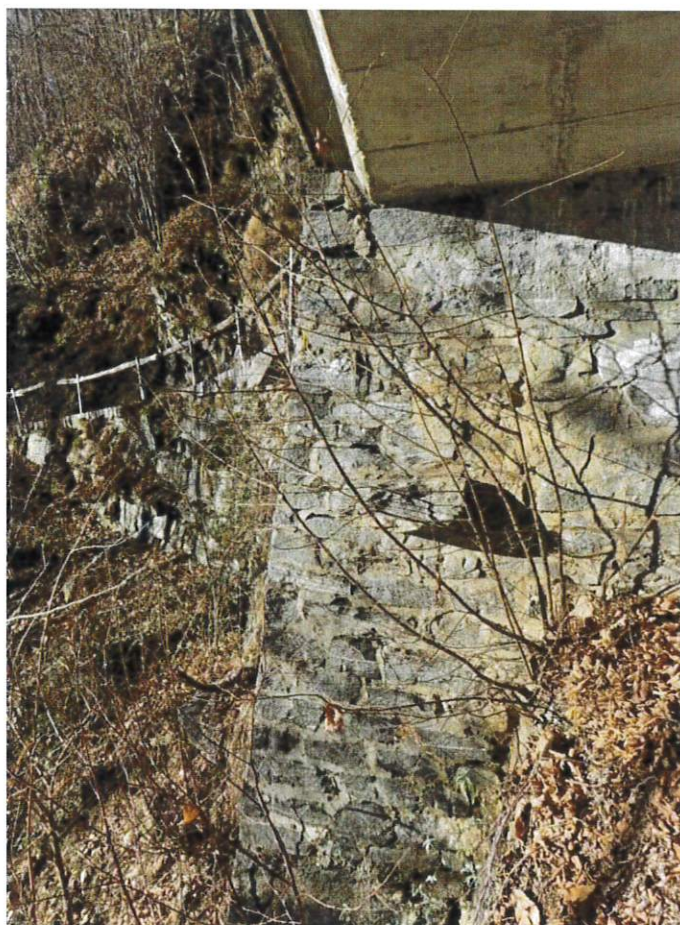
Ponte 2: dettaglio difetto spalla di monte lato lago
